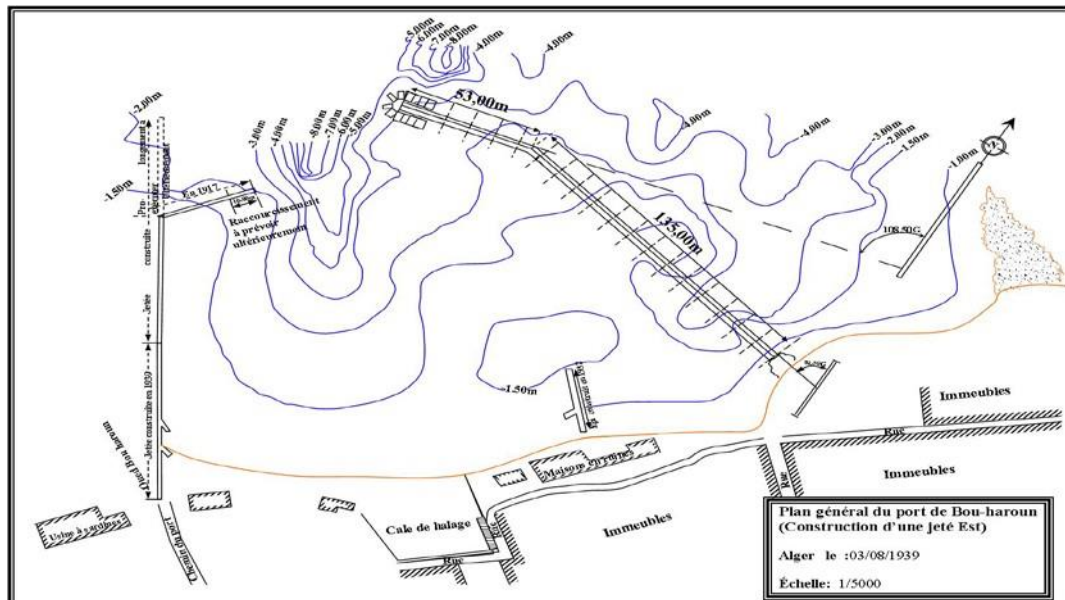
Plan général du port de Bouharoun, Construction d'une jetée Est en 1939
